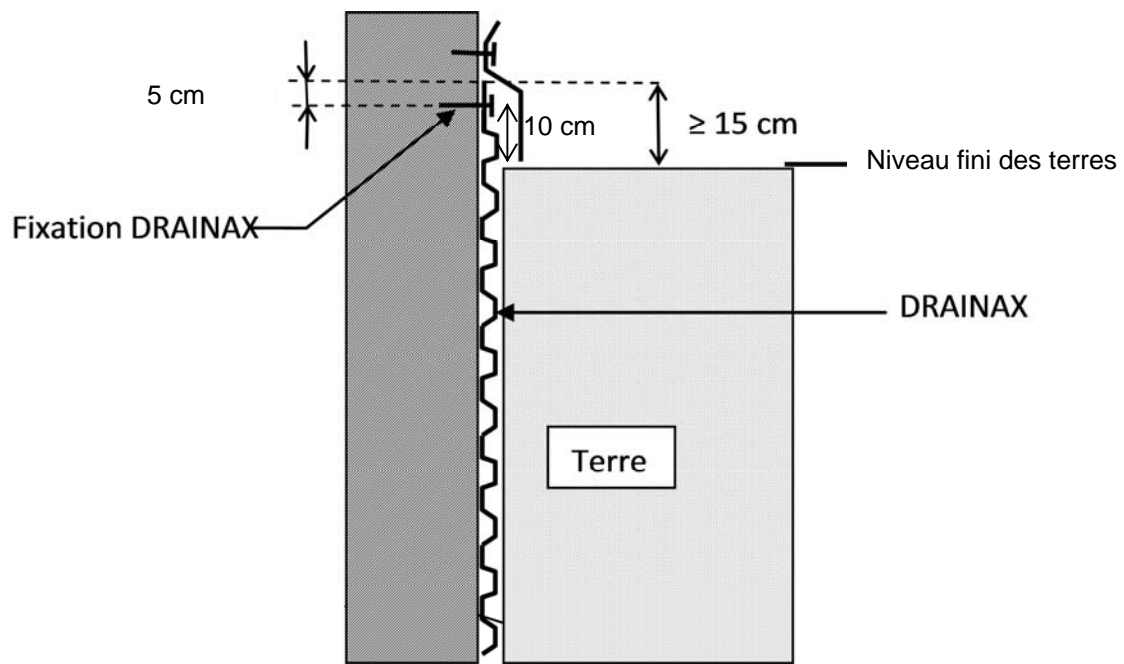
Arrêt supérieur du DRAINAX G sur support nu, enduit ou revêtement d'étanchéité
